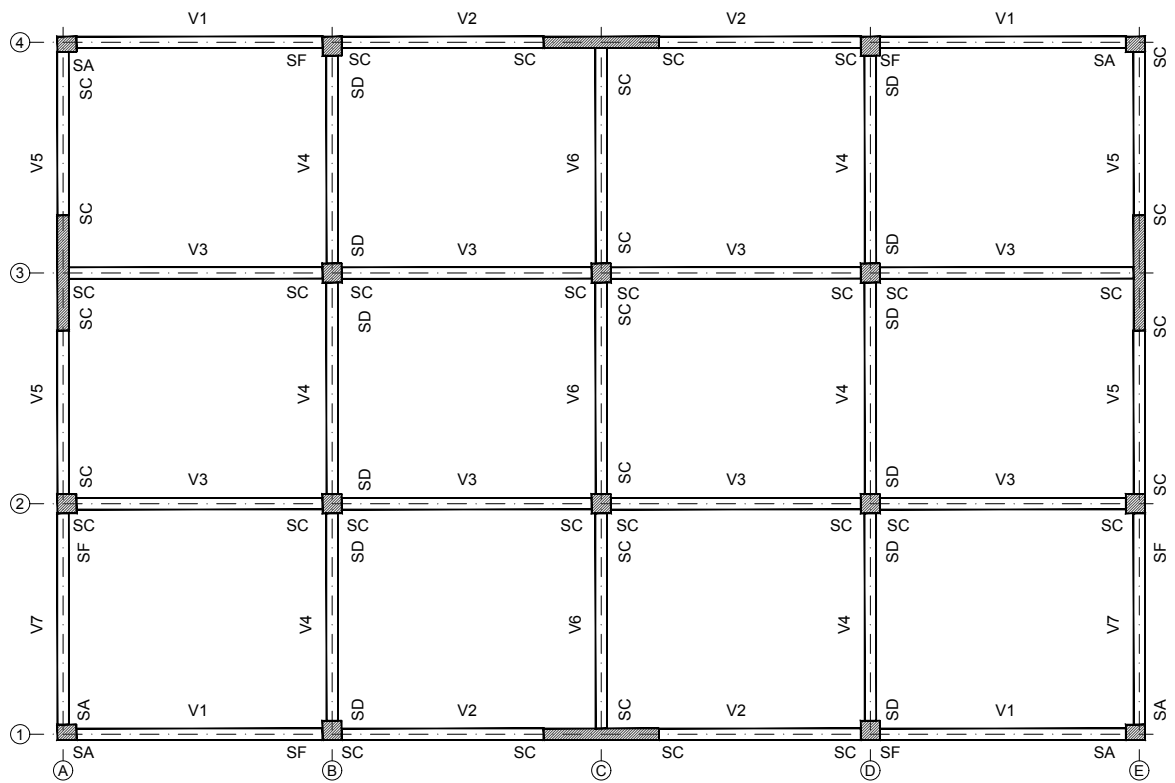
Vigas e secções de armadura – Pisos 2 a 8.
